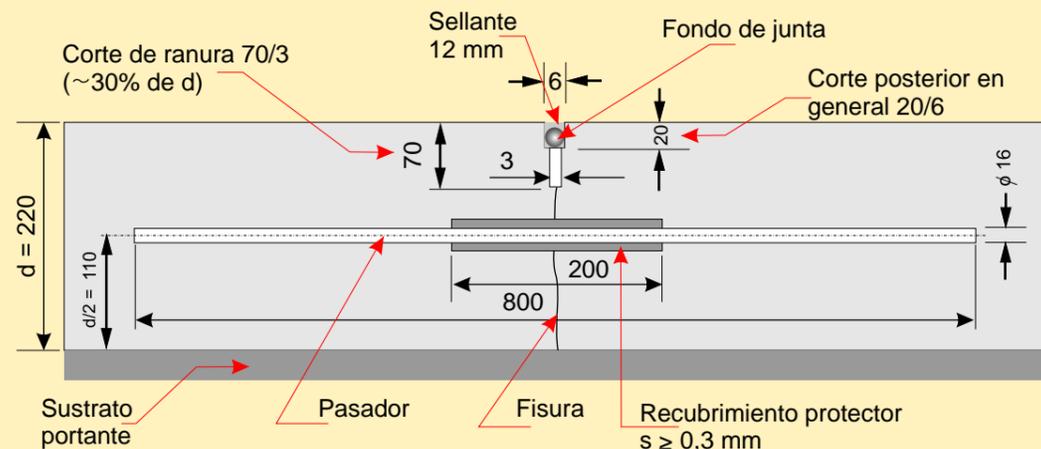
Juntas longitudinales inducidas entre losas de concreto de vía [3].
